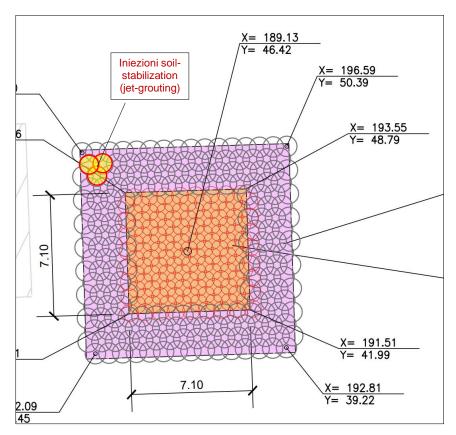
Ubicazione campo prova e colonne di jet-grouting
